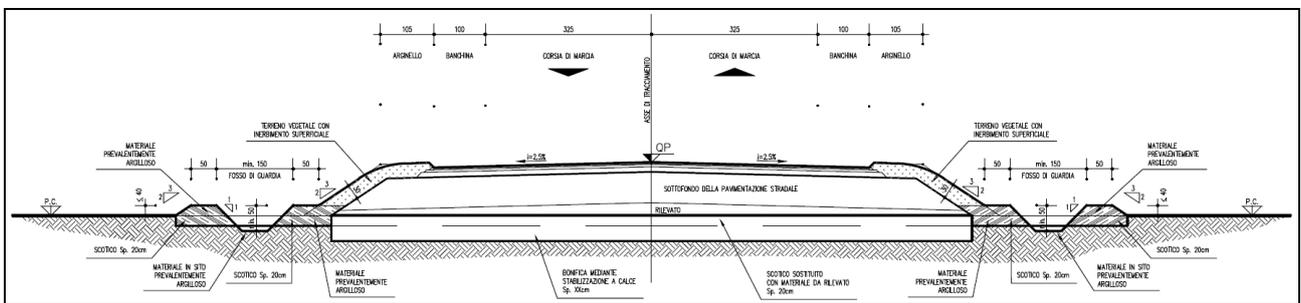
SEZIONE TIPO STRADA VIAZZOLO PICCA DI NUOVA PROGETTAZIONE
